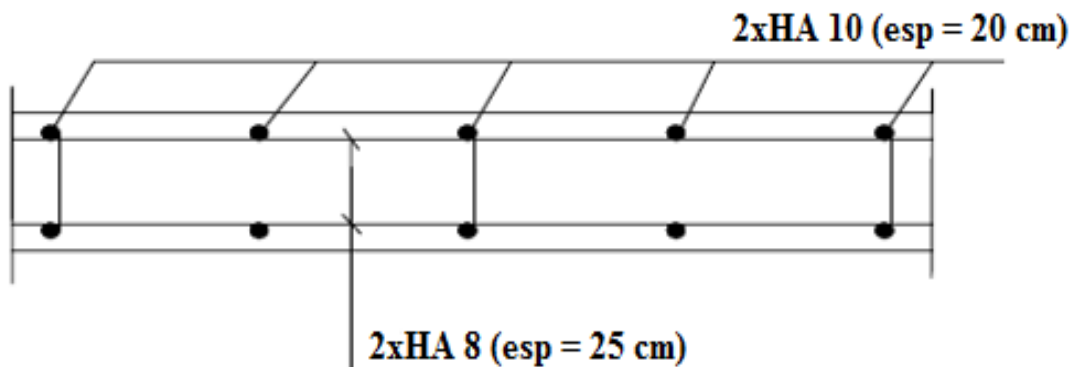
schéma de ferrailage du balcon COUPE B-B
